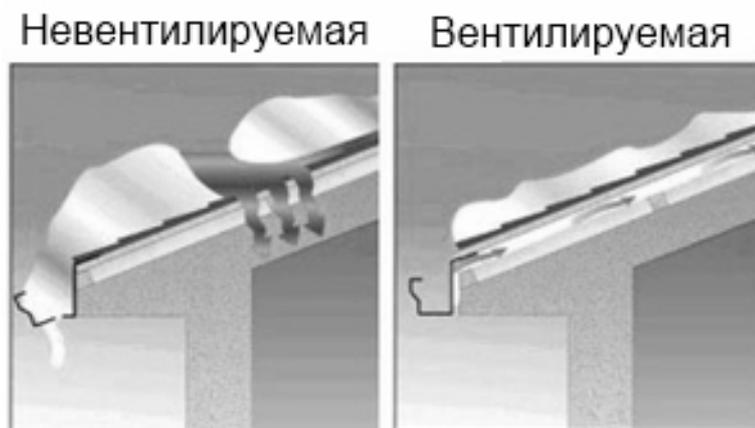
Таяние снежного покрова на невентилируемой и вентилируемой кровлях
